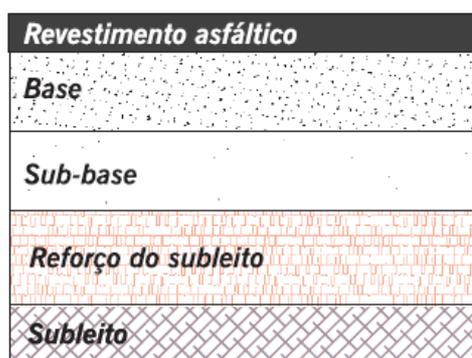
Exemplo de estrutura de pavimento com revestimento asfáltico
